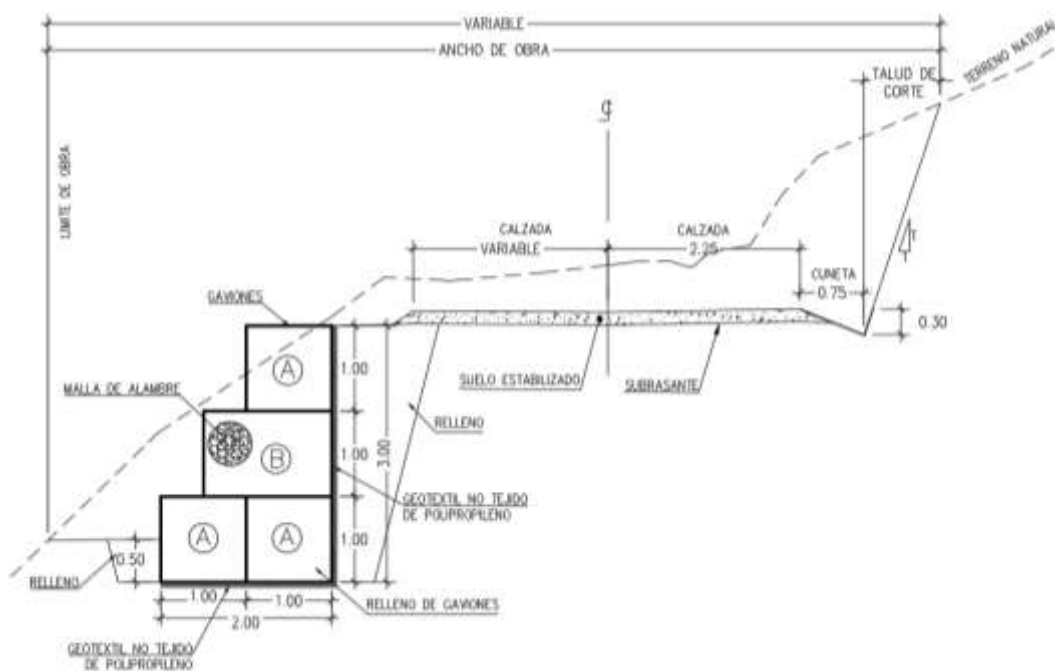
Sección típica a media ladera con muro tipo gavión. Fuente:Plano de secciones típicas.
